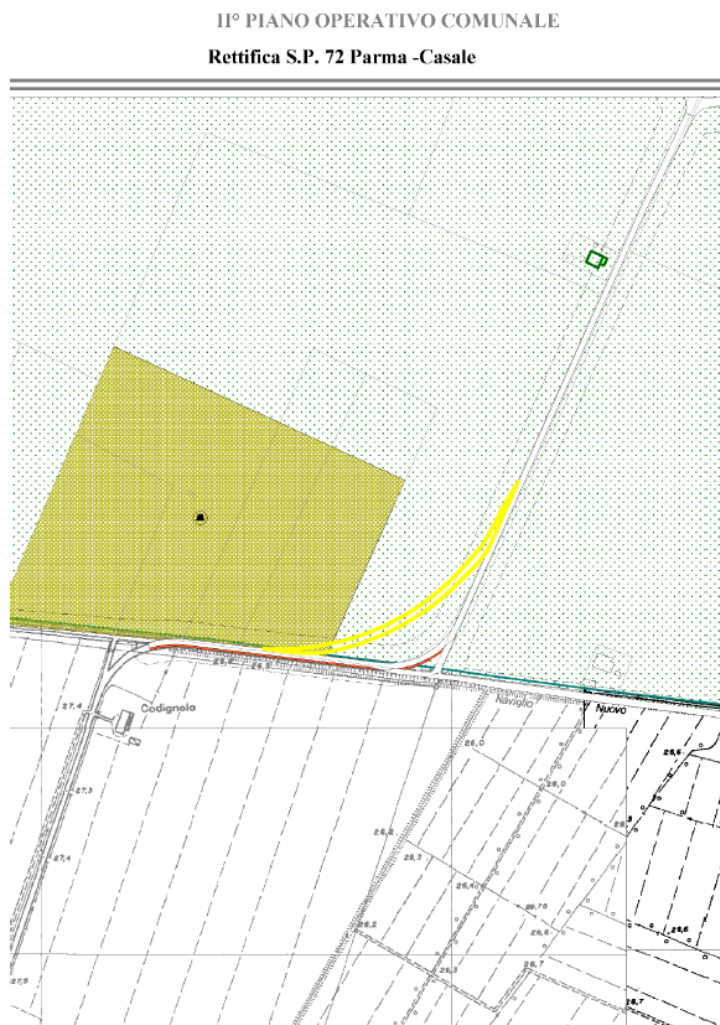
Estratto Progetto Rettifica SP72 Parma-Casale - POC Mezzani
